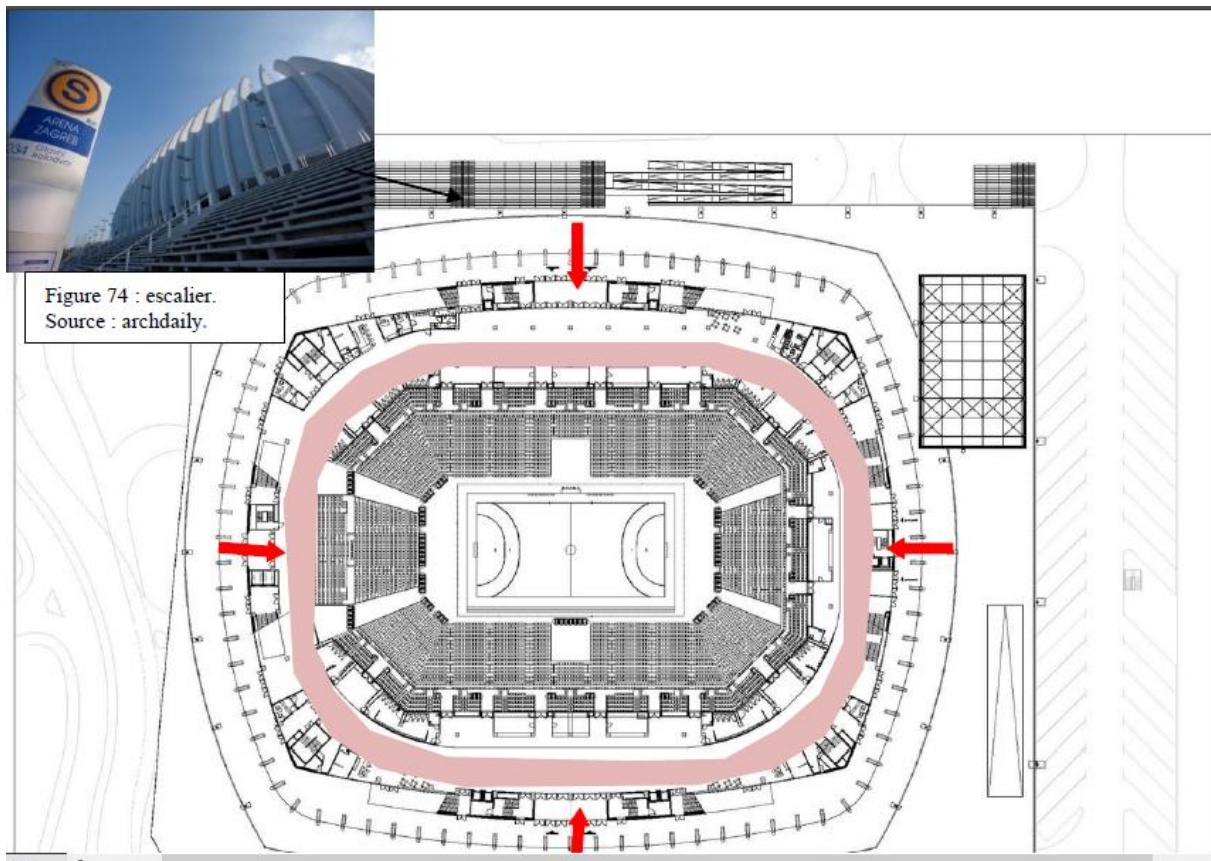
Plan du RDC Arena, Zagreb, Croatie.
